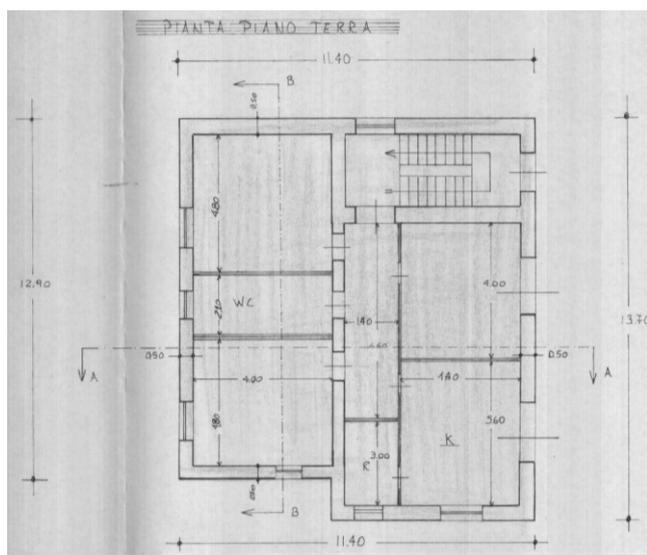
planimetria urbanistica CE in sanatoria n.53/e
